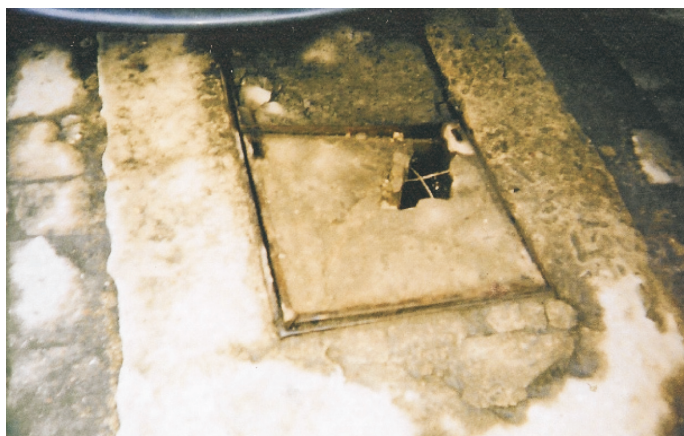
Pokrywa żelbetowa zainstalowana w pasie ruchu kołowego kategorii KR2;
